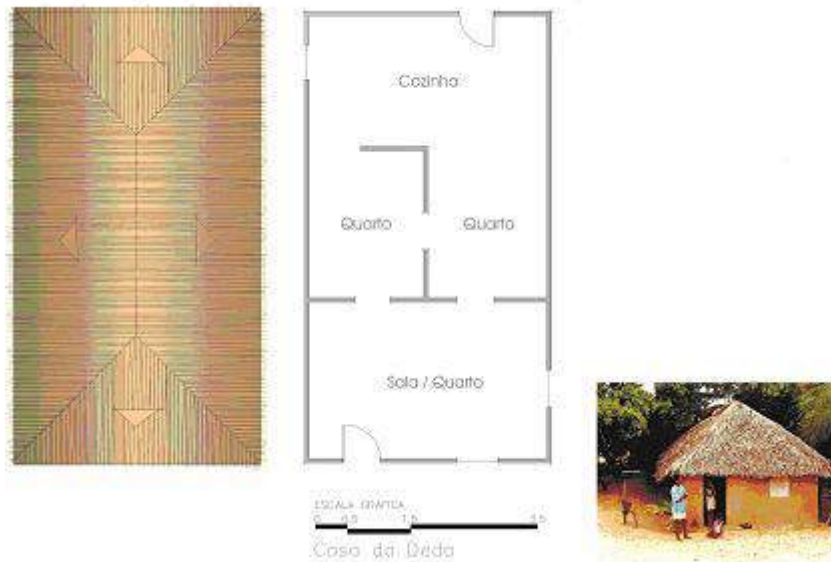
Casa de taipa em Pixaim com planta da cobertura e respectiva planta baixa
